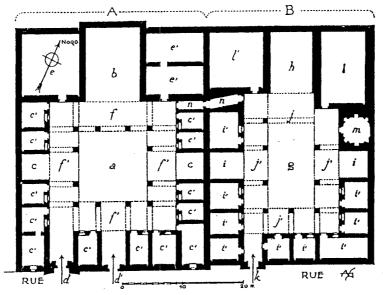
مسقط أفقي لمدرسة قره طاى في قونية ٦٤٩هـ/١٢٥١م .
